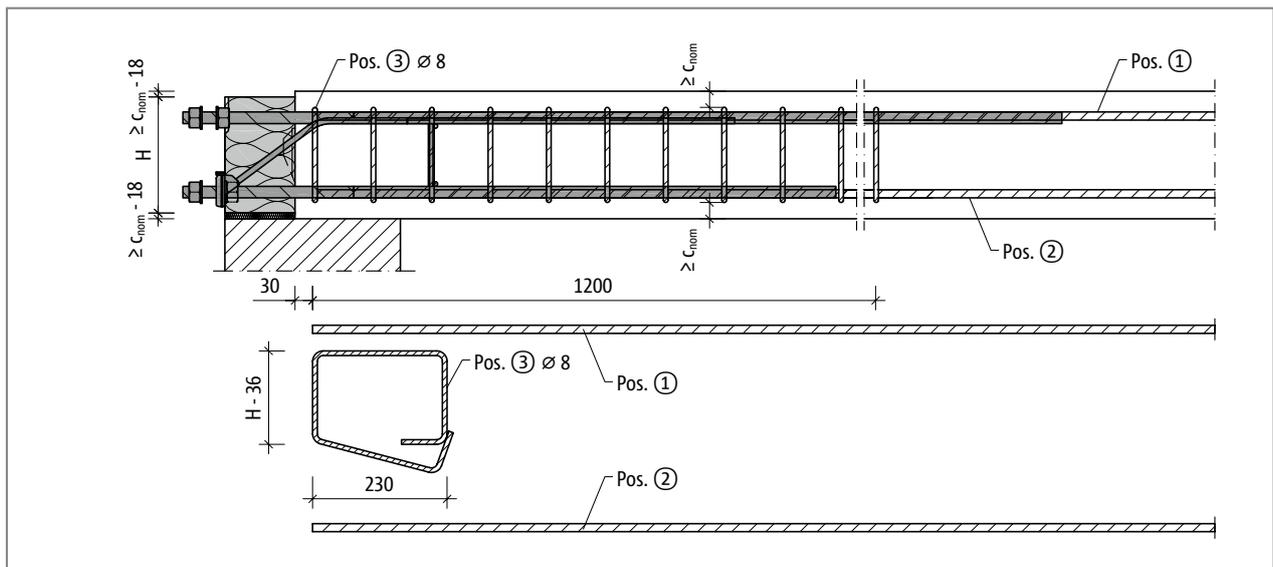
Schöck Isokorb® XT Typ SK-MM2: Bauseitige Bewehrung mit Bügel  $\varnothing 8$  mm; Schnitt
